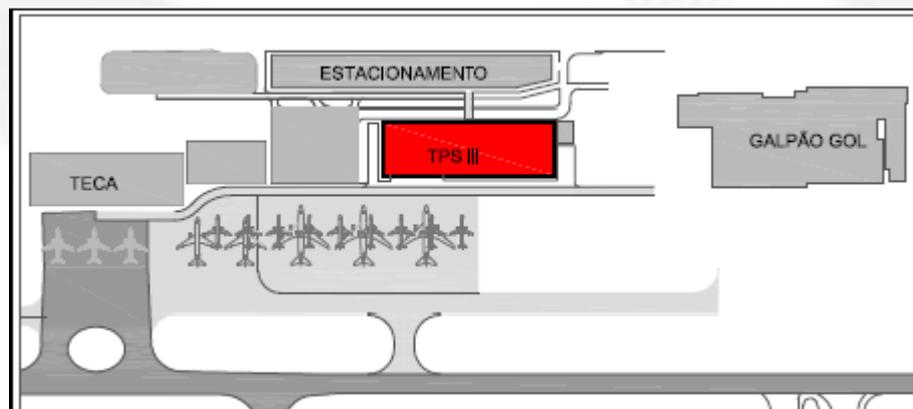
Planta original de situação do TPS 3 - Fonte: EIA.
